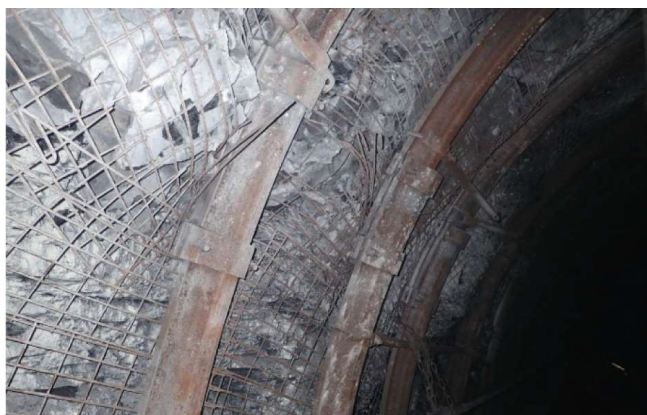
Zdjęcie chodnika PW-1 za skrzyżowaniem ze ścianą – odcinek badawczy I z wykorzystaniem kotew strunowych
